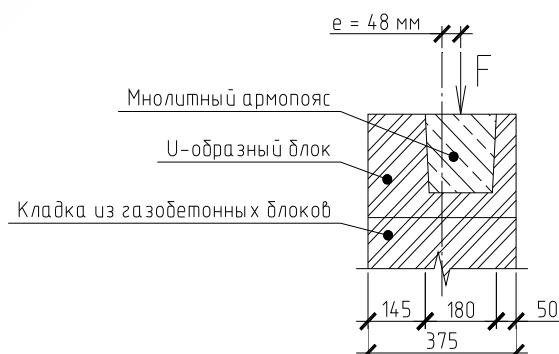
Схема приложения нагрузки на стену при толщине стены 375 мм.
